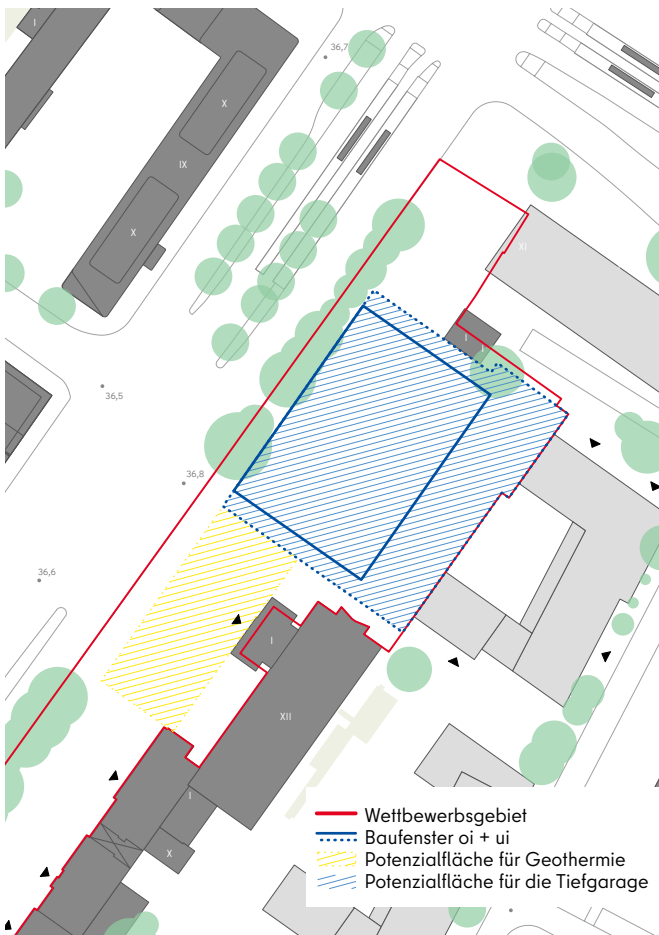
Lageplan mit Darstellung der Potenzialflächen für Geothermie und UG/Tiefgarage
